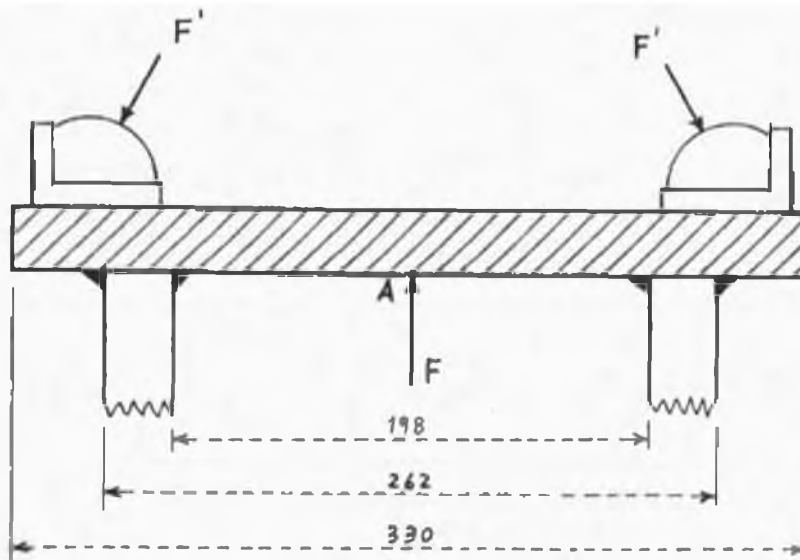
Fuerzas que quieren flexar a la placa frontal de la viga.
